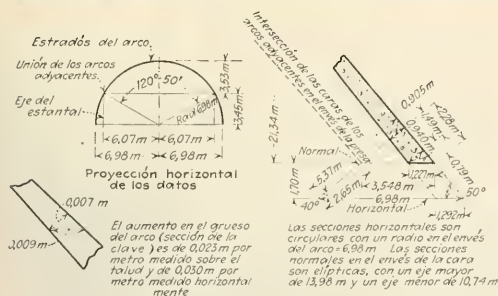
DETALLES DE LA PRESA DE ARQUERÍA
